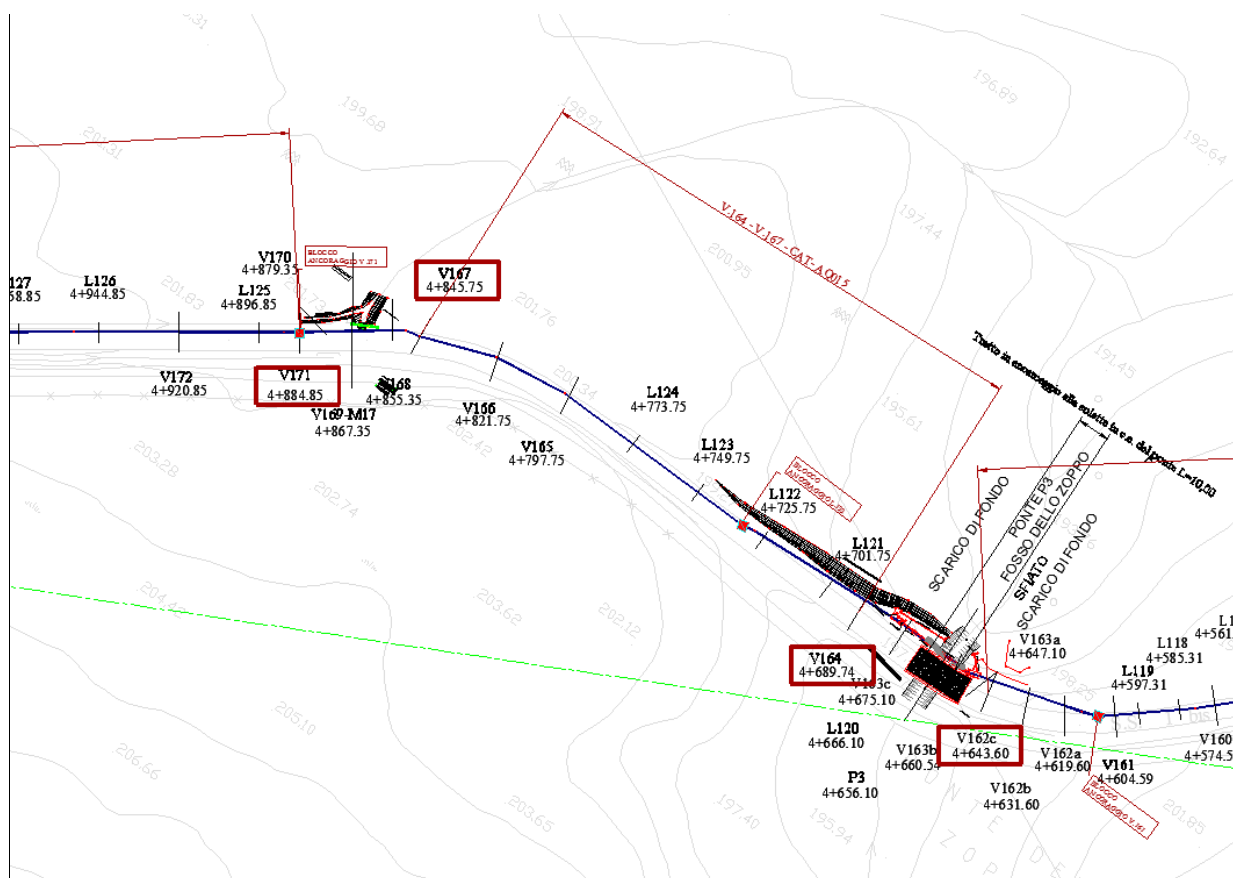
Stralcio delle planimetrie "as built" del nuovo acquedotto di Monte Romano
